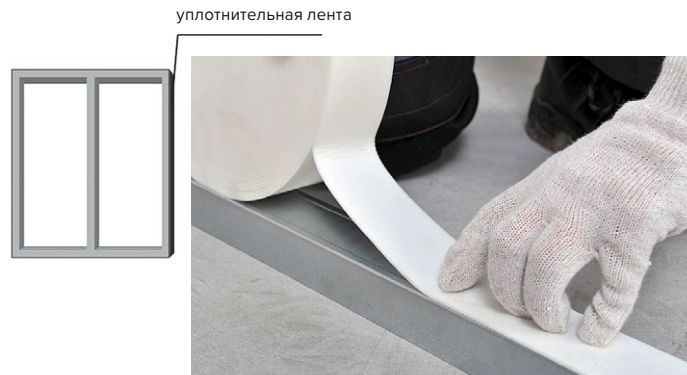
Схема расположения и приклейка уплотнительной ленты в каркасе
